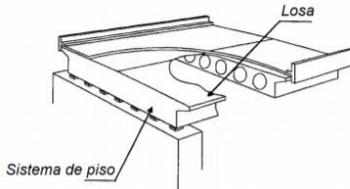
Sistema de viga losa. Fuente: MOPT, (2007)
